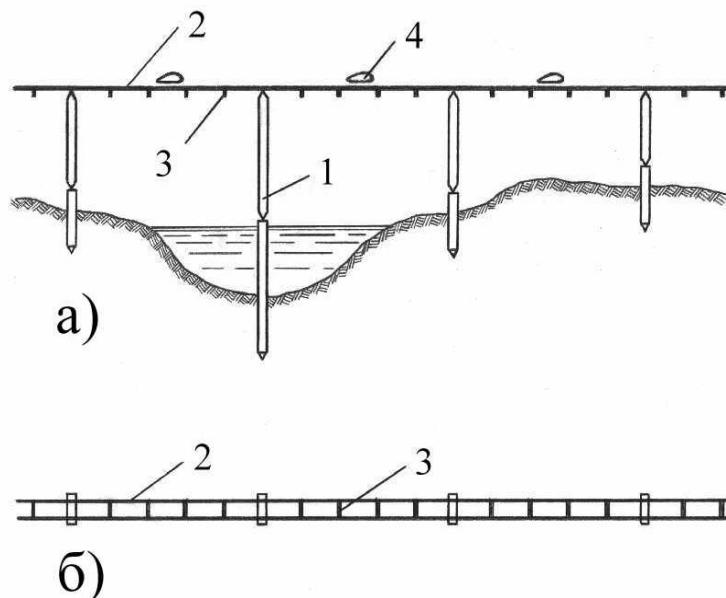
Схема размещения поперечных планок по длине трассы: а) вид сбоку на СТЮ; б) вид сверху; 1 – поддерживающая опора; 2 – рельс; 3 – поперечная планка; 4 – транспортный модуль
